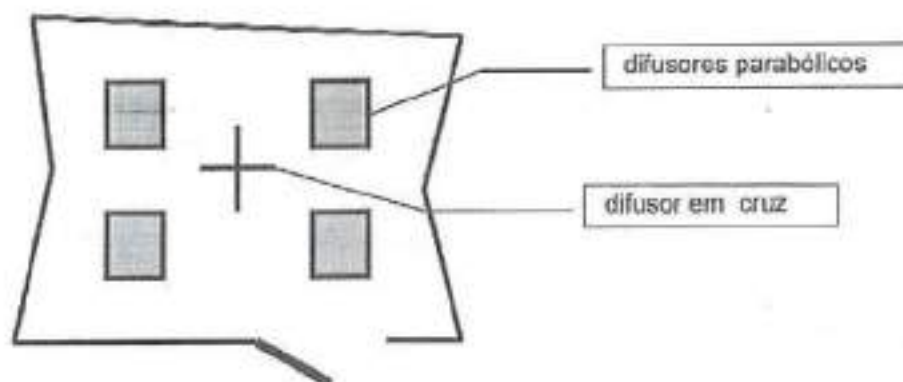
Croqui da câmara reverberante do LaTA.
